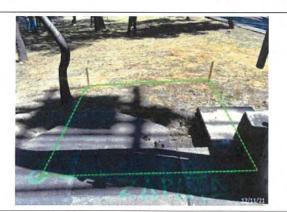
En verde se observa cimentaciones pertenecientes a la columna 16 a un costado de Boulevard Adolfo López Mateos.
